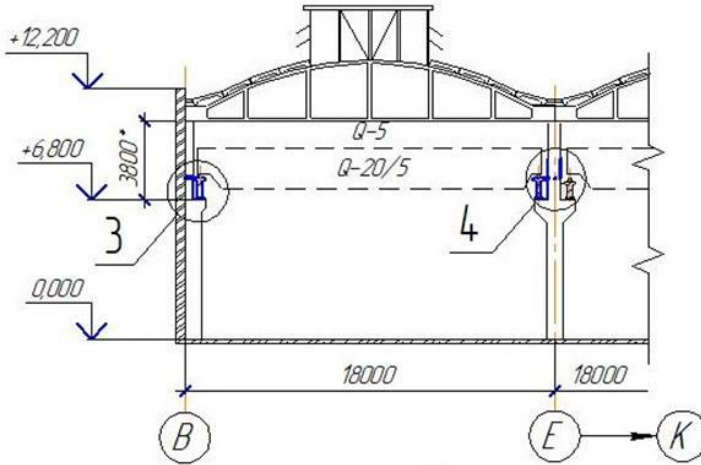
Поперечний розріз монтажного цеху промислової будівлі в осях В-Е
